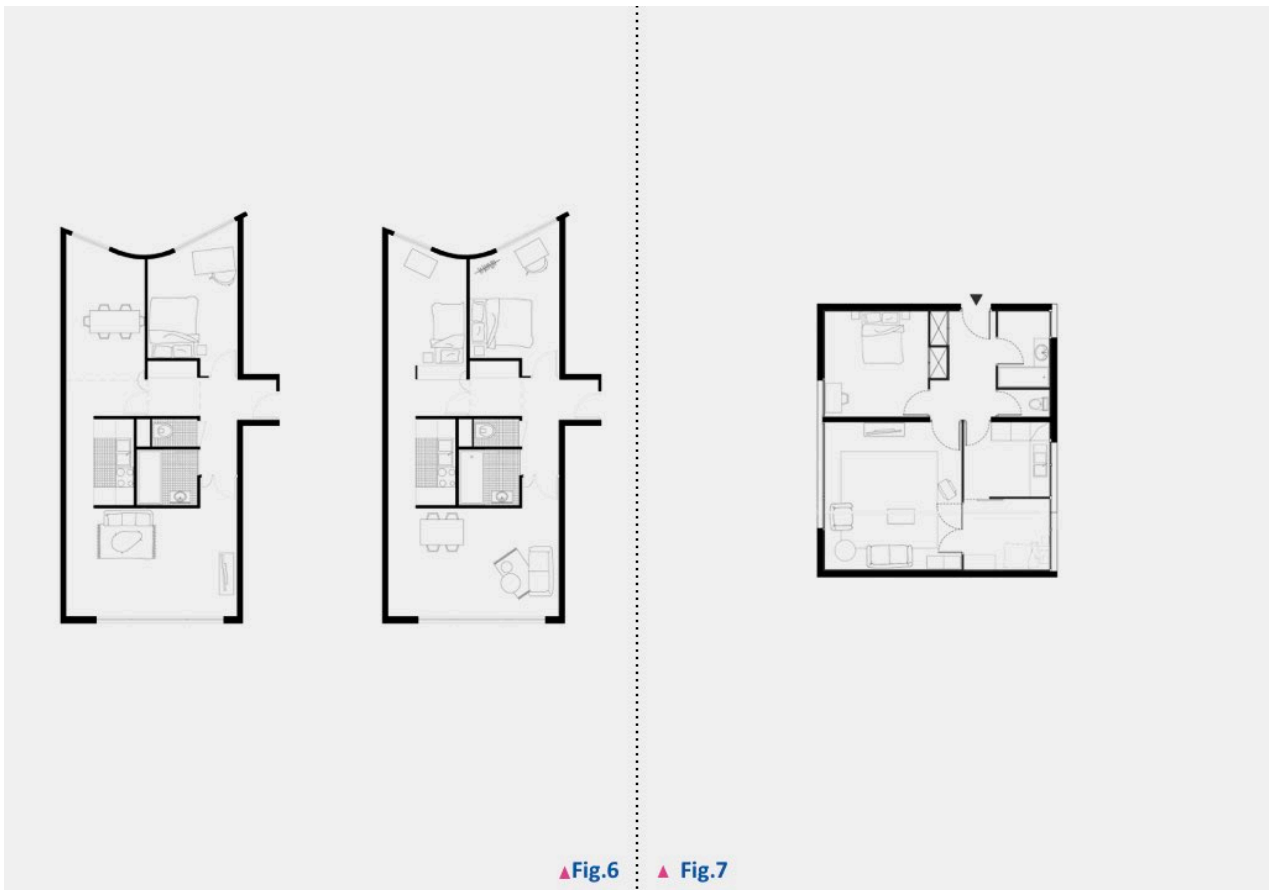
Plan d'un logement avec le bloc central. 33 Logements et bureau de Poste
